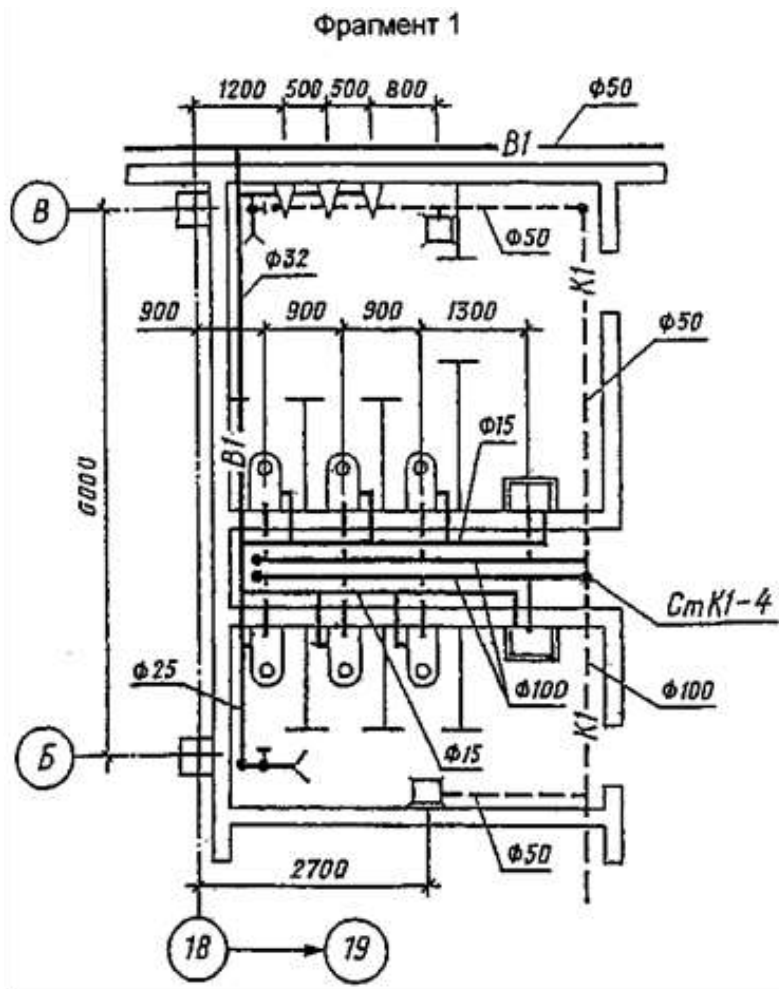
Приклад оформлення Фрагменту 1 плану систем водопроводу і каналізації будівлі
